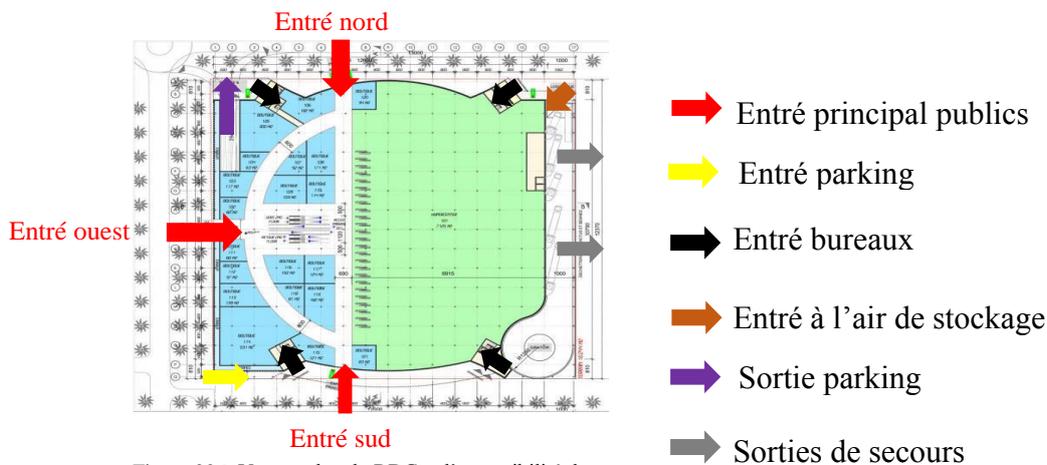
Vue en plan du RDC et l'accessibilité du centre commercial de Bab Ezzouar.
